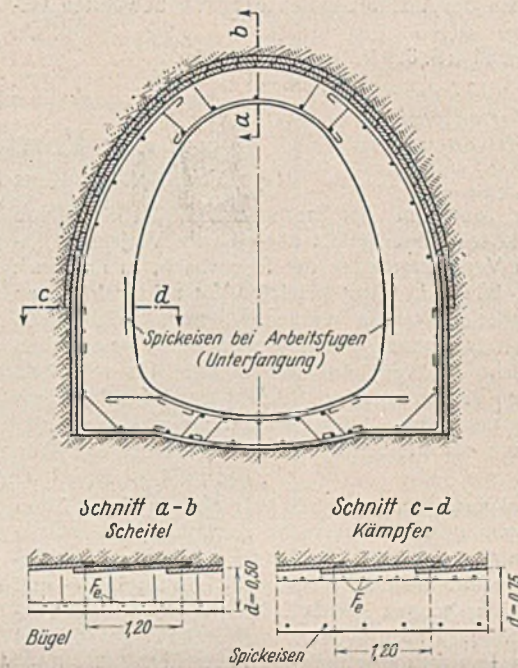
Verstärktes Gewölbe des Tunnels der Abb. 10 u. 11, einfach bewehrt, Ausbruchbogen herausgenommen. Wirtschaftlichste Ausführung.
